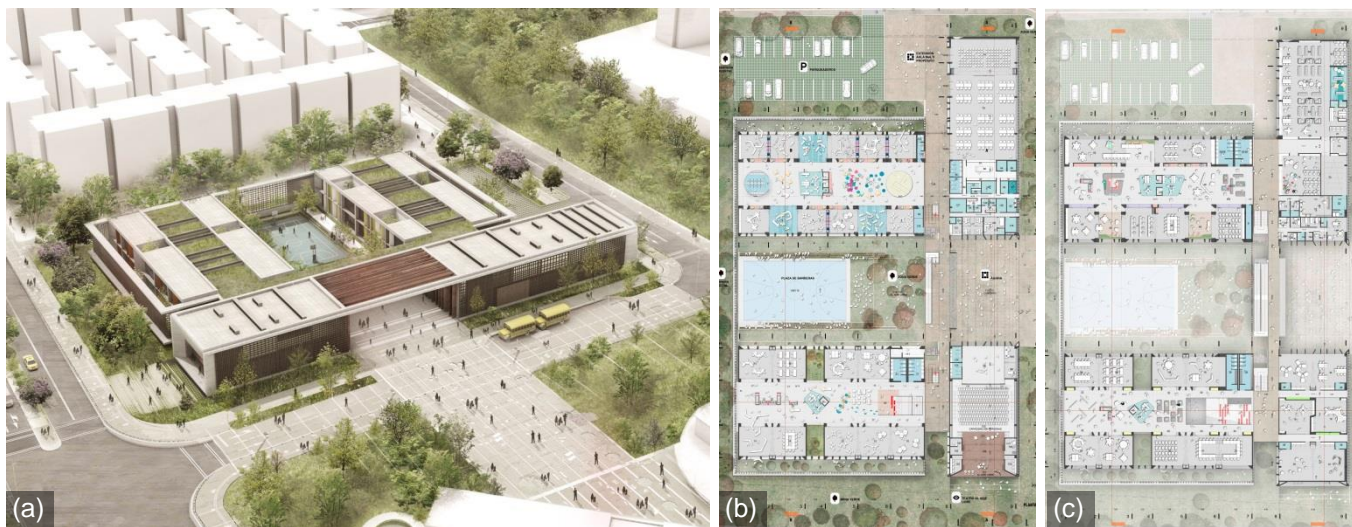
(a)(b)(c): Perspectiva e planta-baixa do térreo e do segundo pavimento
